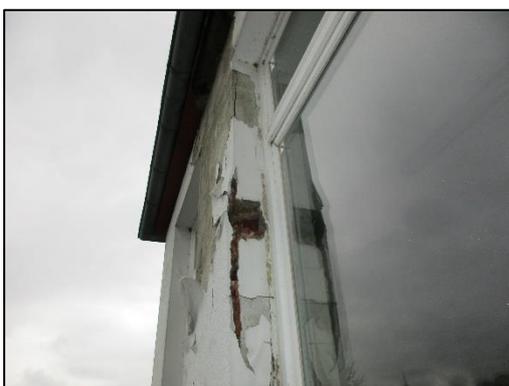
Spalten im Mauerwerk (Gebäude Nr. 15)
